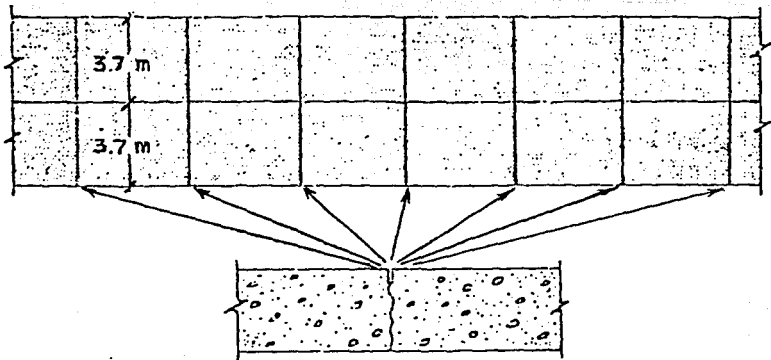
Pavimento de concreto simple - juntas de contracción sin refuerzo
